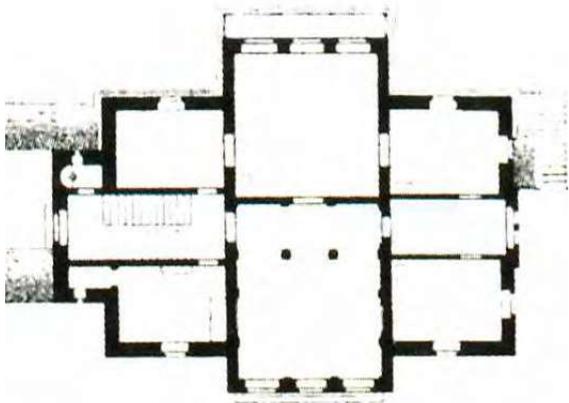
Villa Hebra Grundriss, 1869.
